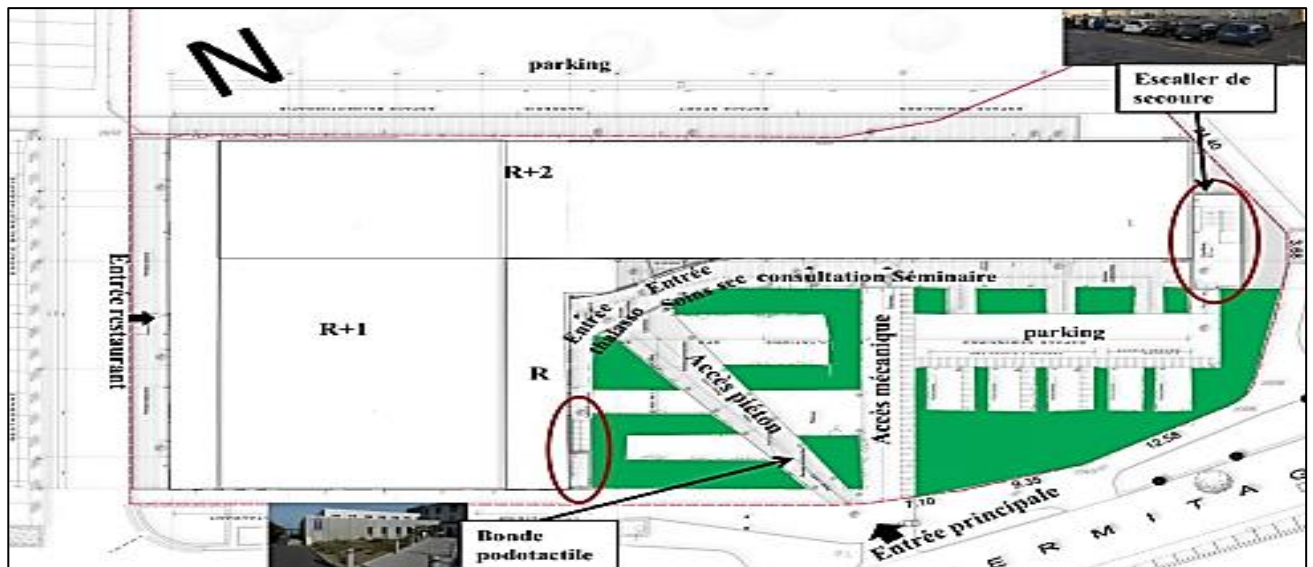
64: Plan de masse du centre thalassothérapie de sidi Fredj
